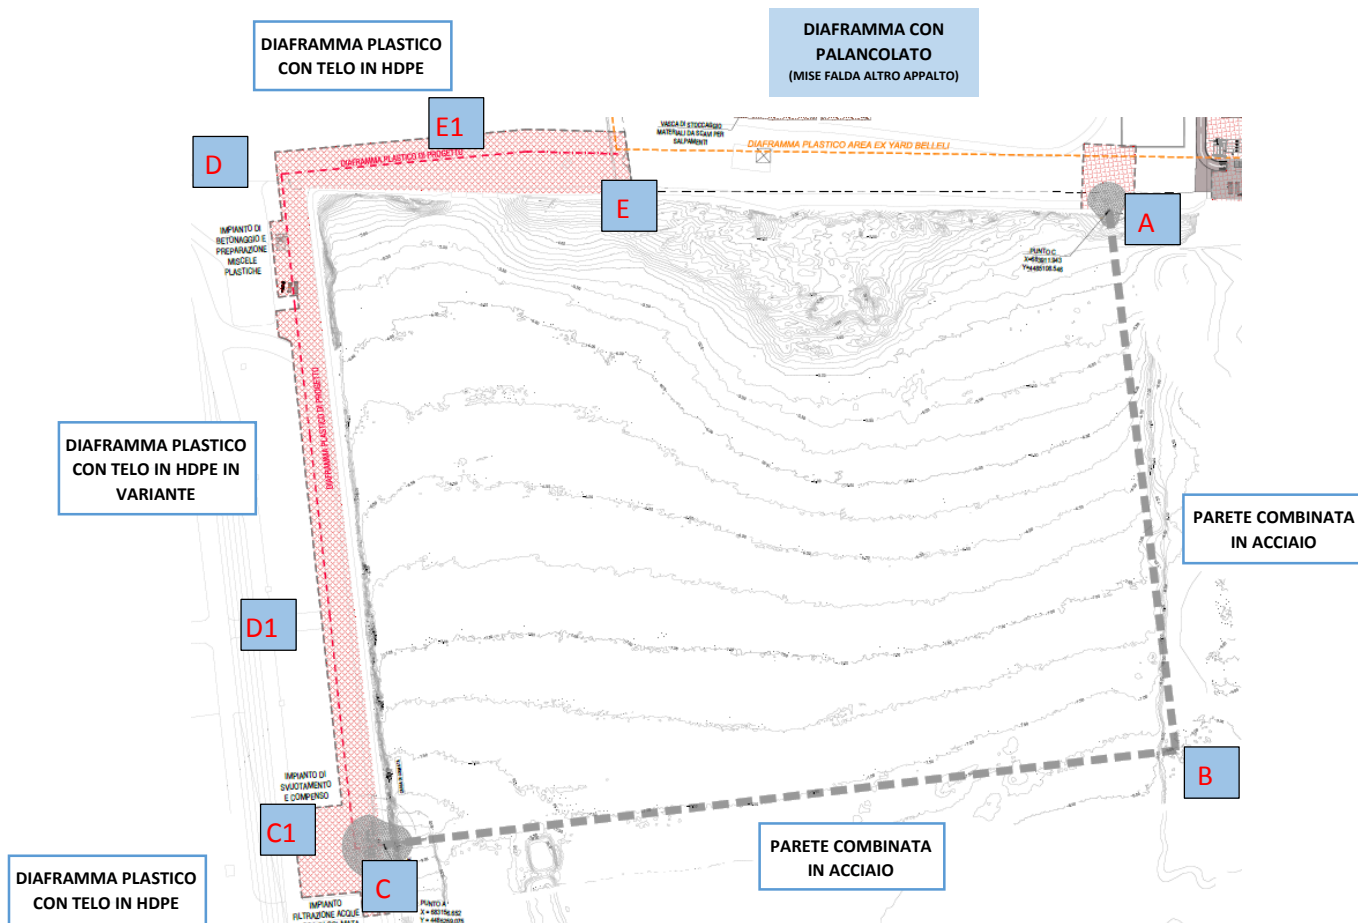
Nuova planimetria ubicazione marginamento a terra.
